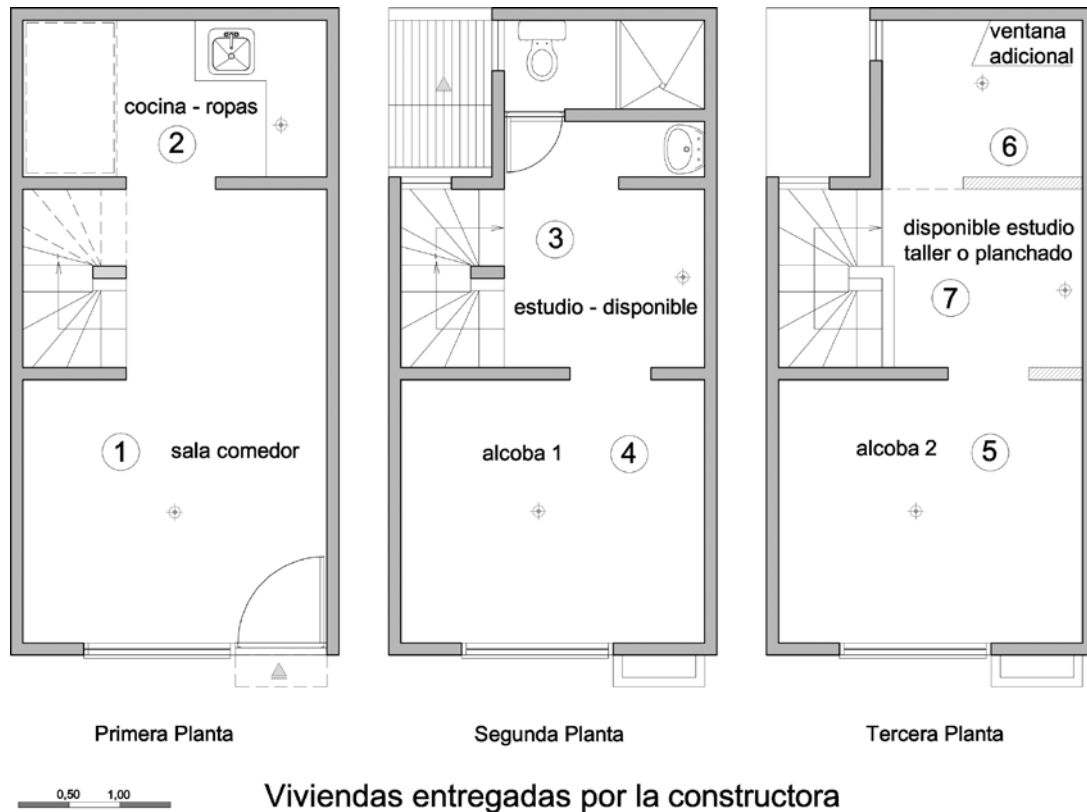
Planimetrías viviendas objeto de estudio prueba piloto
